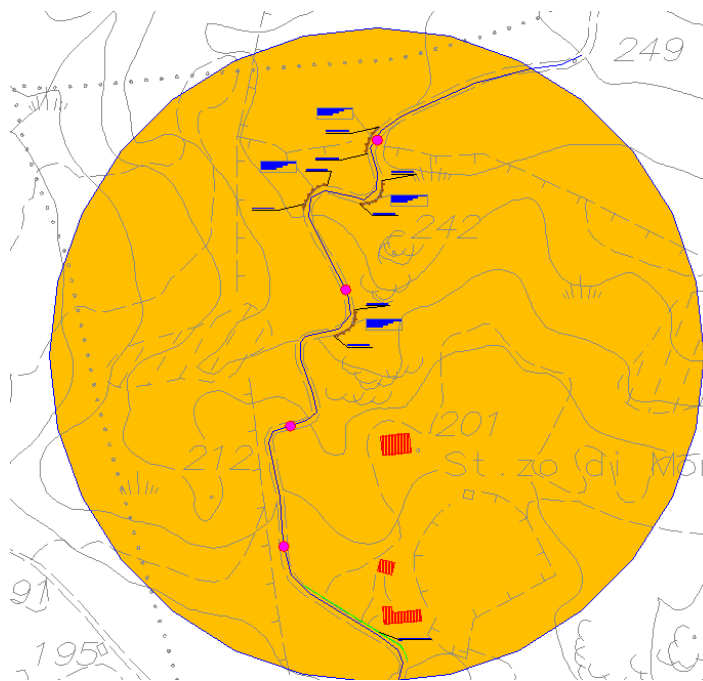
Comune di Arzachena – Strada Monticanu - Estratto planimetria di intervento
